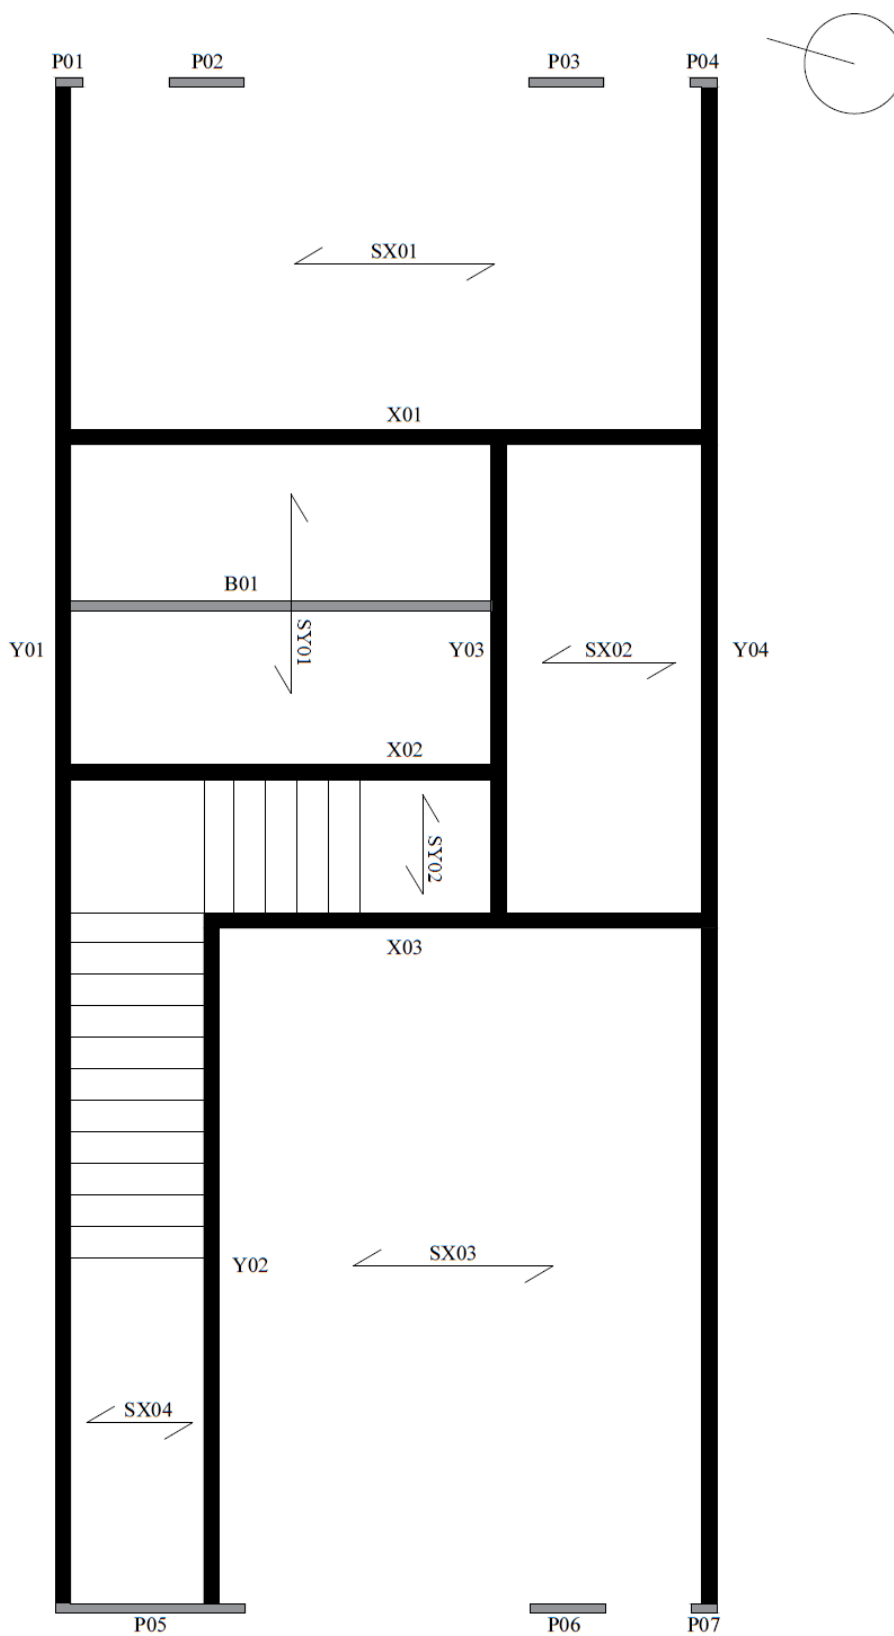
Pianta strutturale 2D rappresentante gli elementi strutturali portanti e non portanti, su Autocad (elaborazione a cura dell'autrice)
